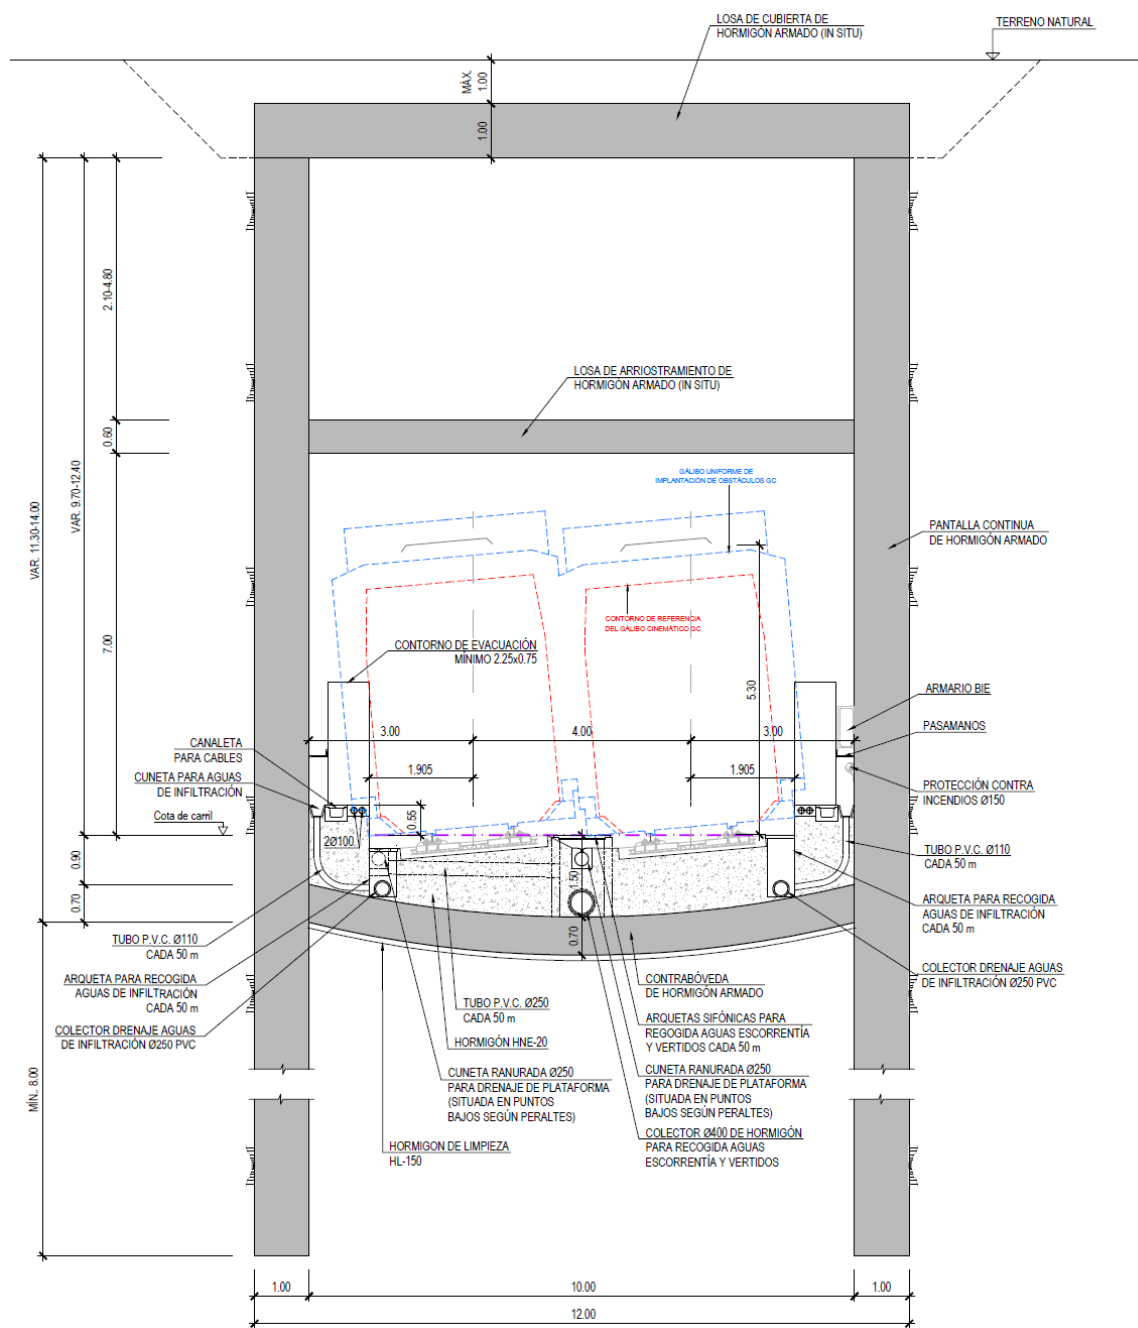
d.- Sección tipo 3 en el tramo soterrado (ST-S3).
